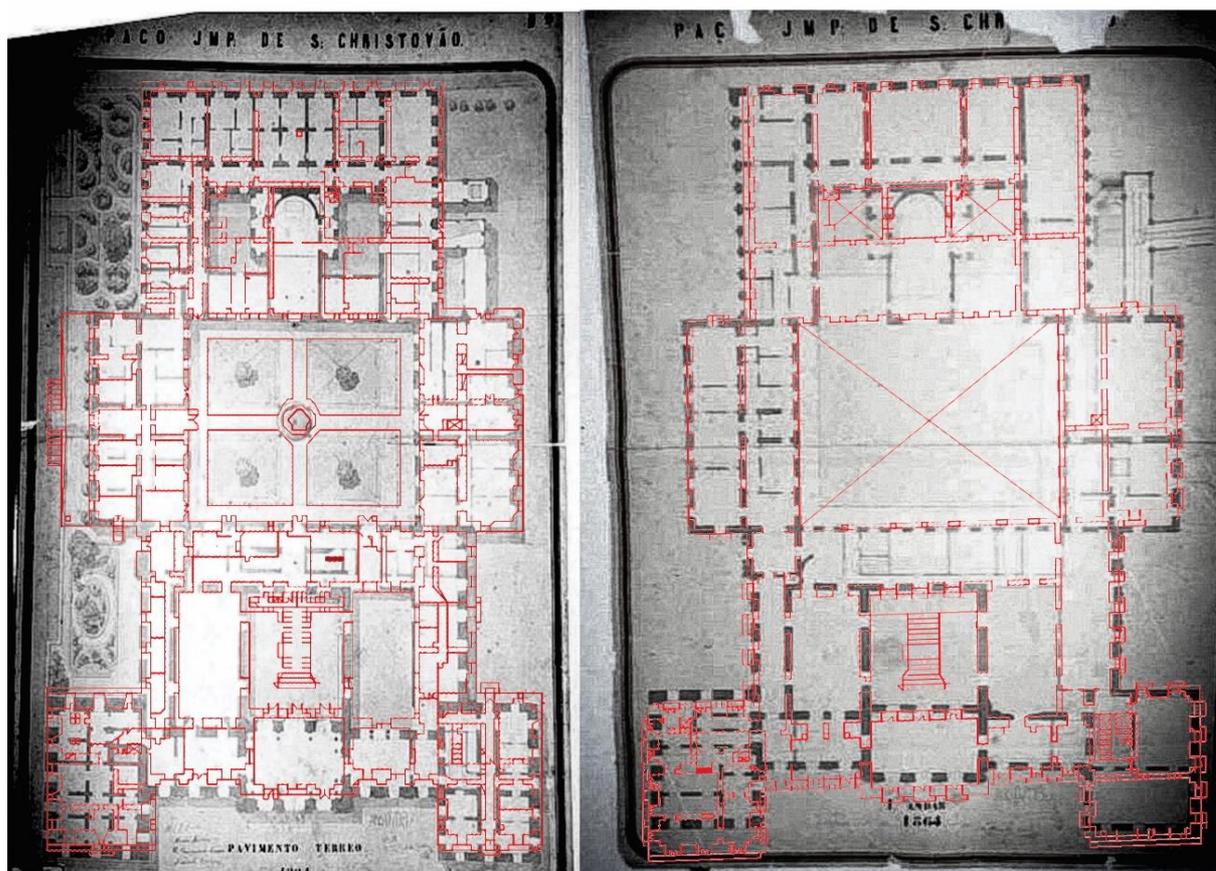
Imagem comparando a planta baixa do PSC com a planta atual sobreposta em vermelho. Fonte planta baixa esquerda: (BIENNE, 2013, p. 265). Fonte planta baixa direita: (BIENNE, 2013, p. 266.). Inserção, em vermelho, da autora.
